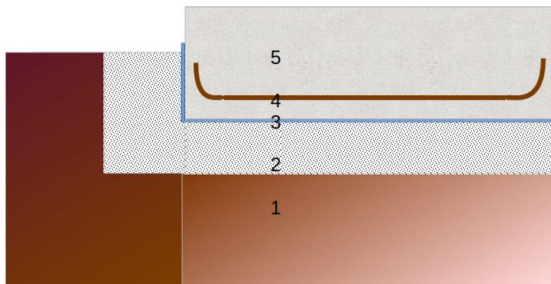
Cimentación: 1. Chan; 2. Grava; 3. Capa Polietileno 1mm antihumidade. 4. Mallado electrosoldado 5. Formigón.
